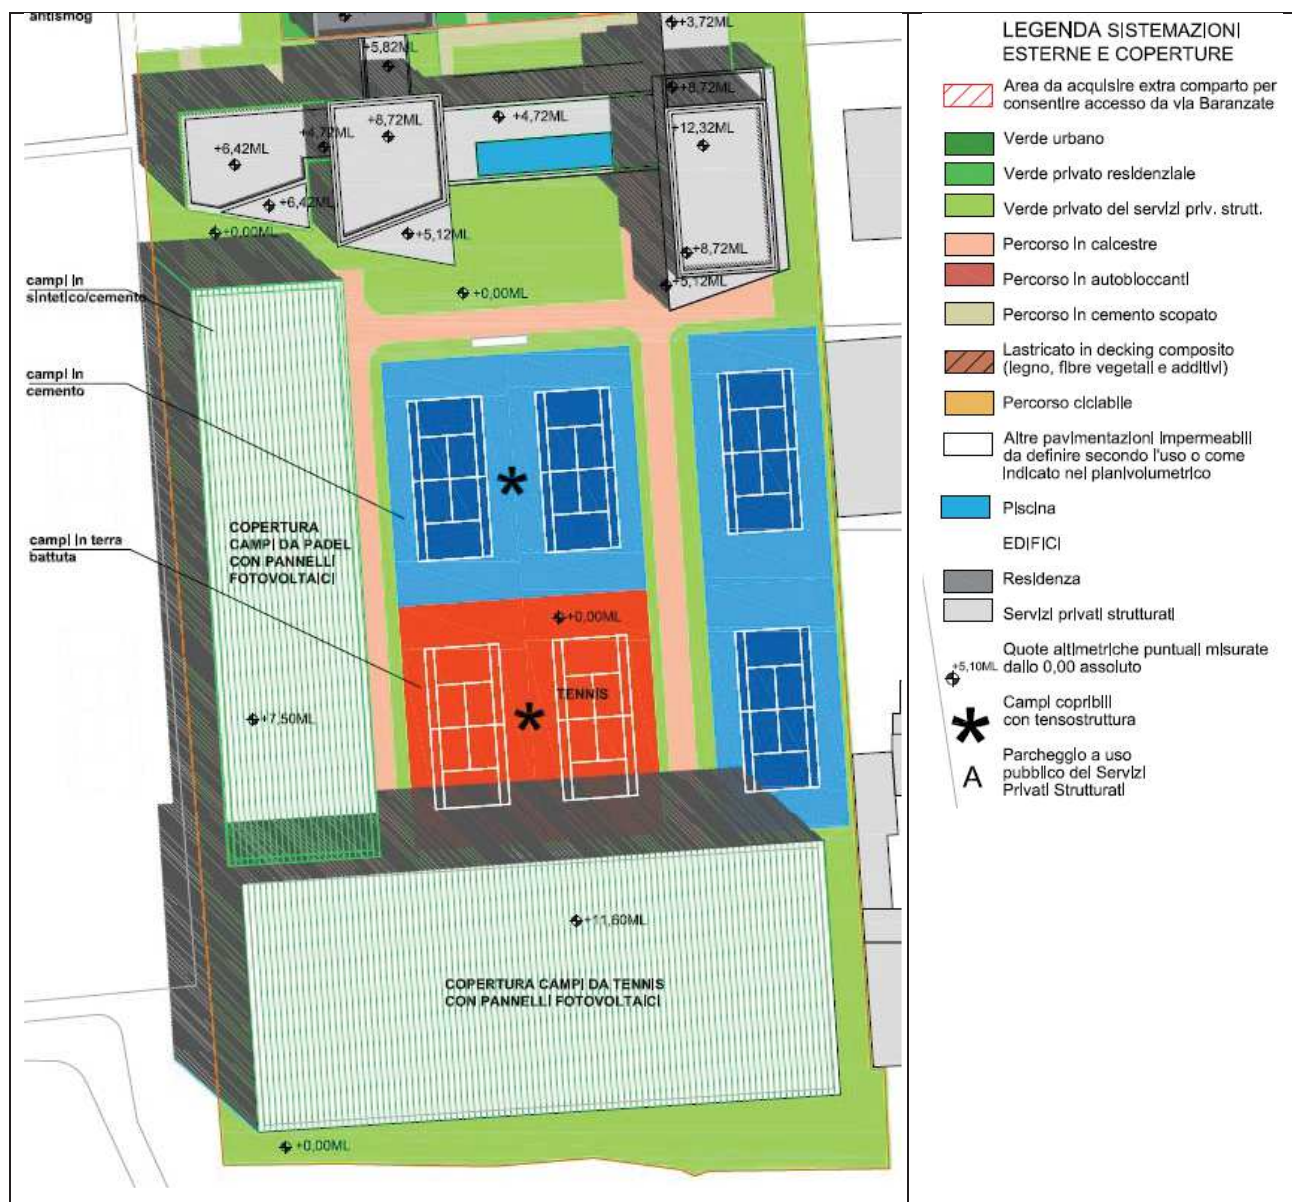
Dettaglio dell'area sportiva (fonte: tav.4 Planivolumetrico di PA)
